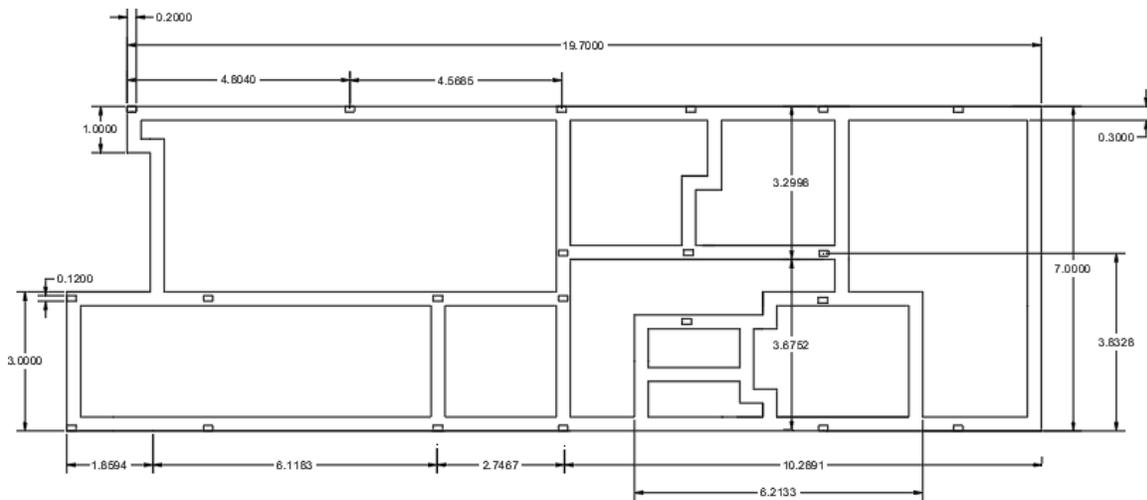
Cimentación AutoCAD. Imagen tomada de: Elaboración propia
